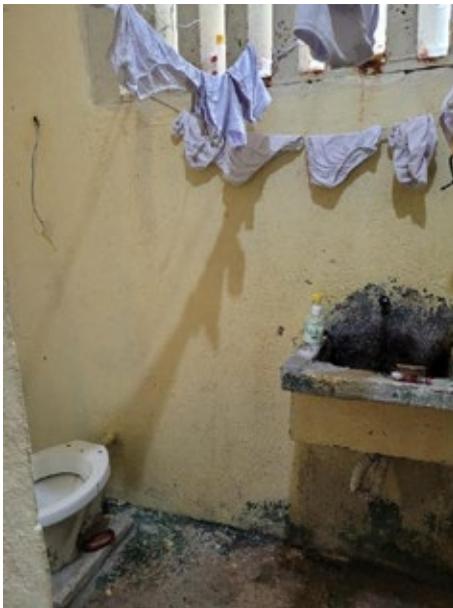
Banheiro degradante de cela do pavilhão de trabalhadoras.
